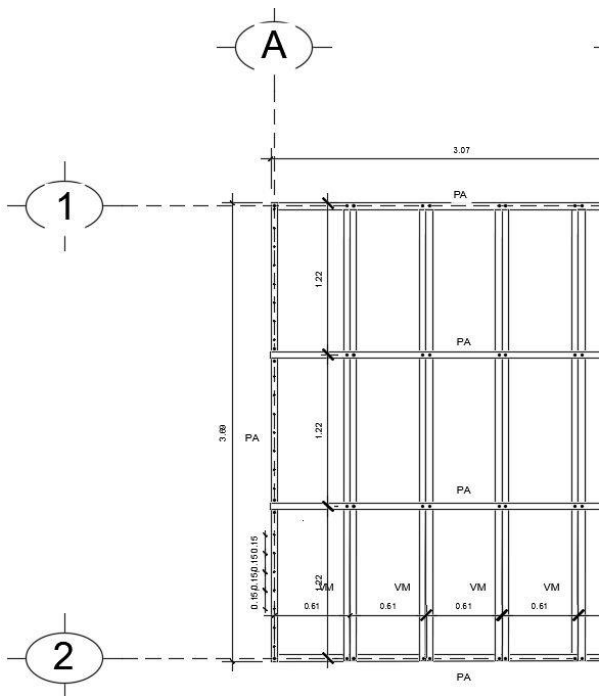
, Armado rigidizador. (Fuente: propia del autor)
